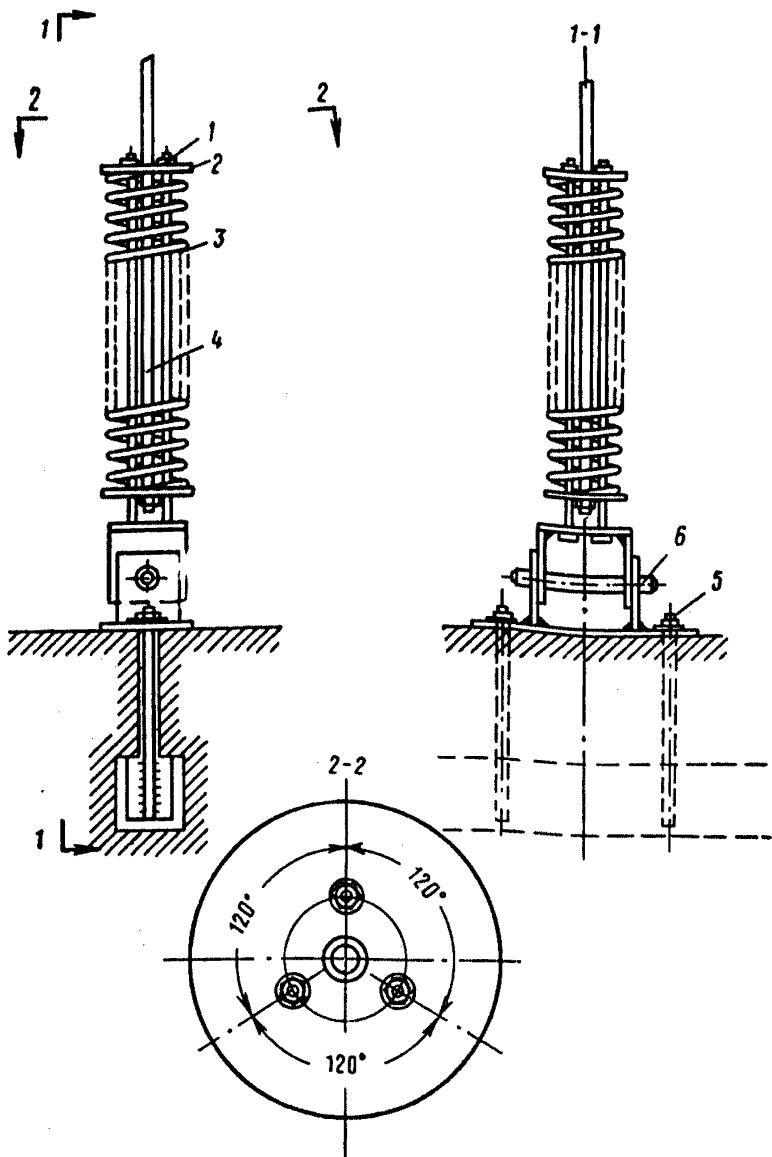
Детали крепления вертикальных тяг испытательного стенда к силовому полу
